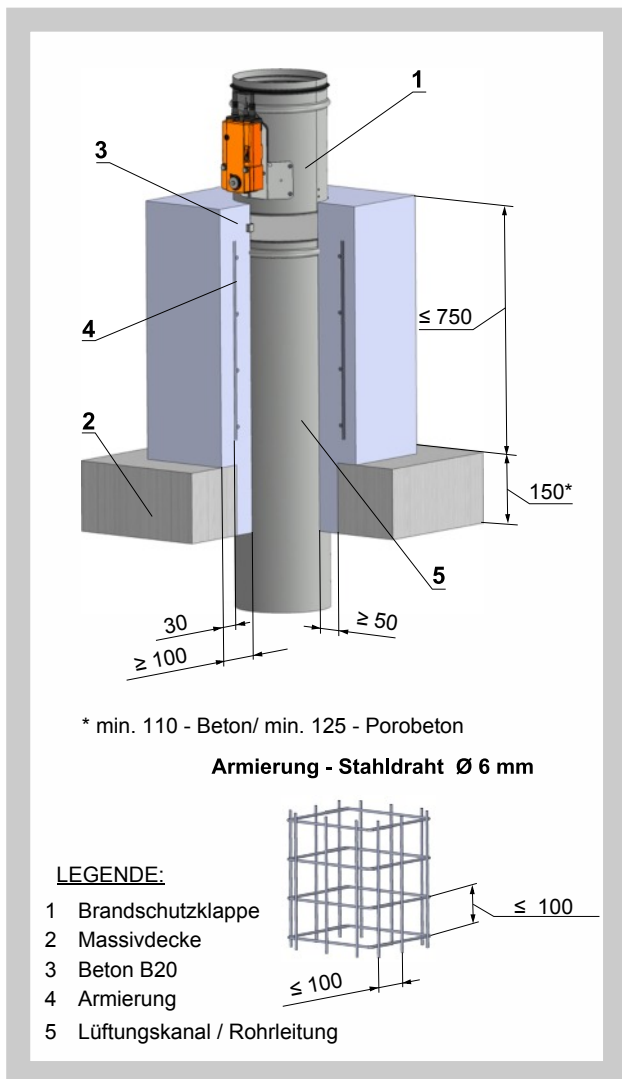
Entfernt von oder an Massivdecken - Nasseinbau - Betonmantel und Einbaurahmen
